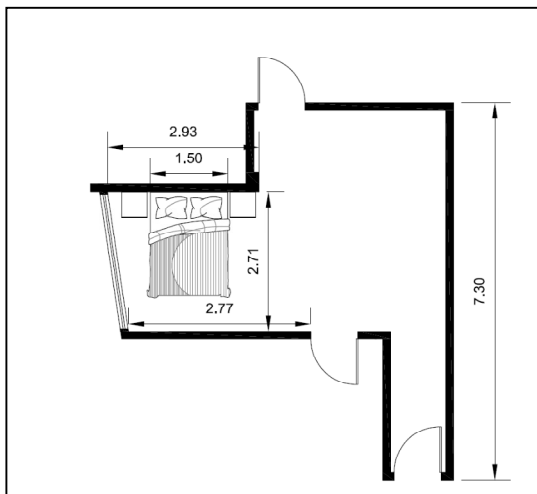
Planta Baixa do quarto de Fernanda – 1ª versão
